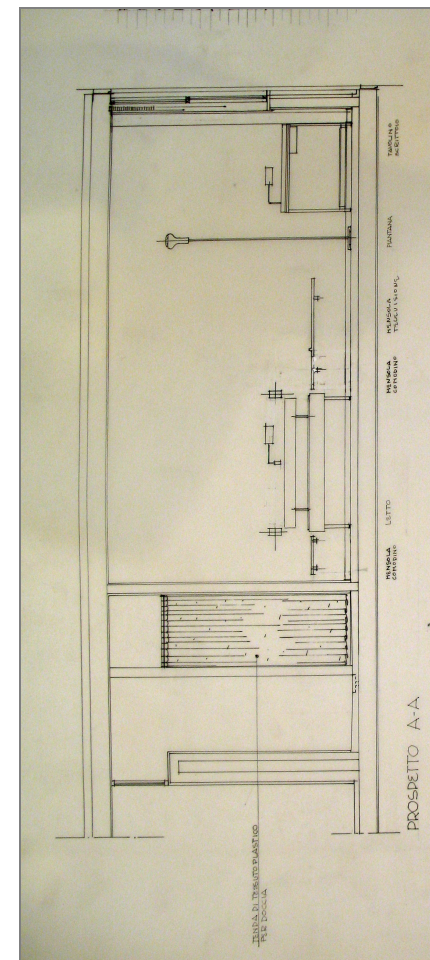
camera tipo, prospetto AA (fonte CSAC – stralcio tav. 33, archivio n. 276-1)
